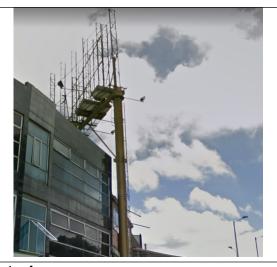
Vista de la estructura donde se evidencia que el panel orientación Sur-Norte fue desmontado
